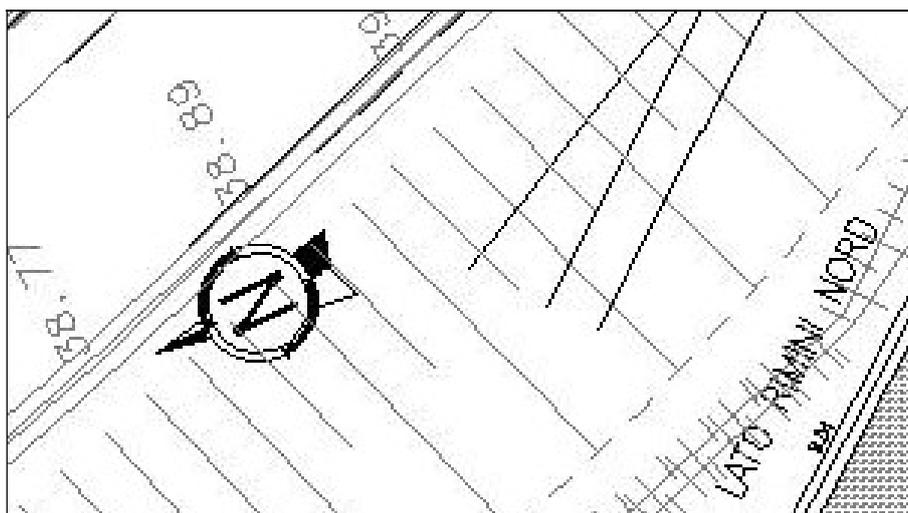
Posizione planimetrica del muro andatore lato Rimini – Allargamento Nord
